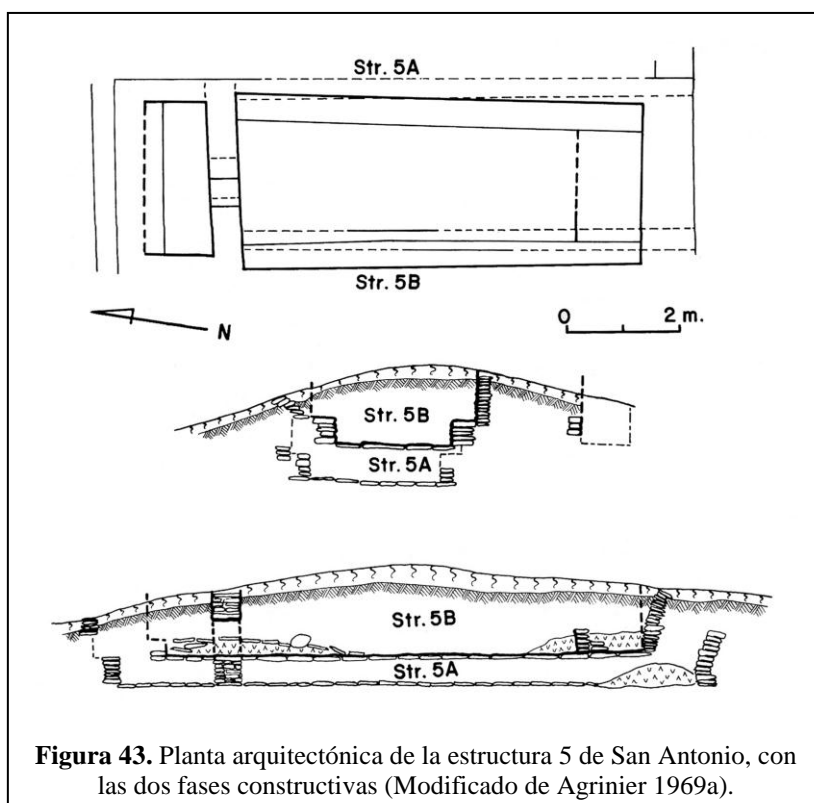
Planta arquitectónica de la estructura 5 de San Antonio, con las dos fases constructivas (Modificado de Agrinier 1969a).
